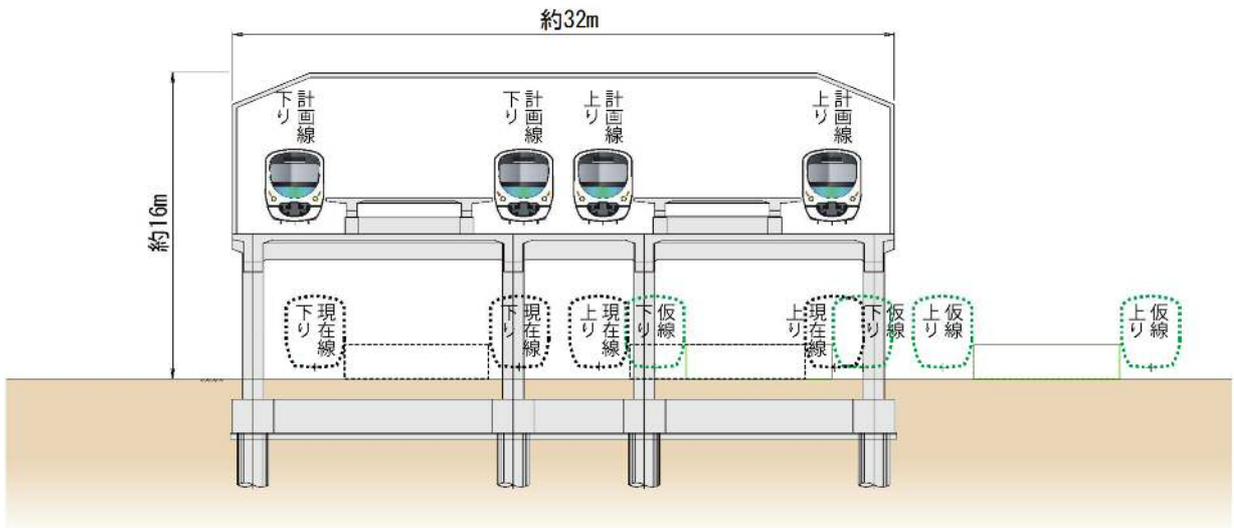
(4) 駅部標準断面図 (G-G' 断面：東伏見駅)
